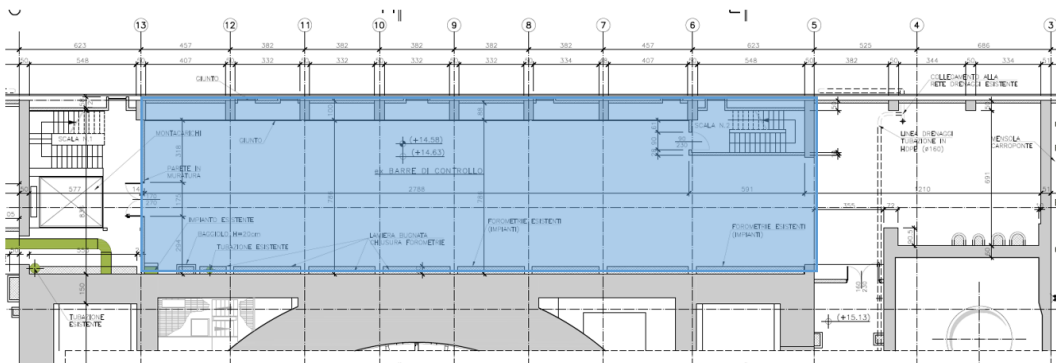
Pianta con indicazione locali quota 14,63 – Corpo Controllo.
